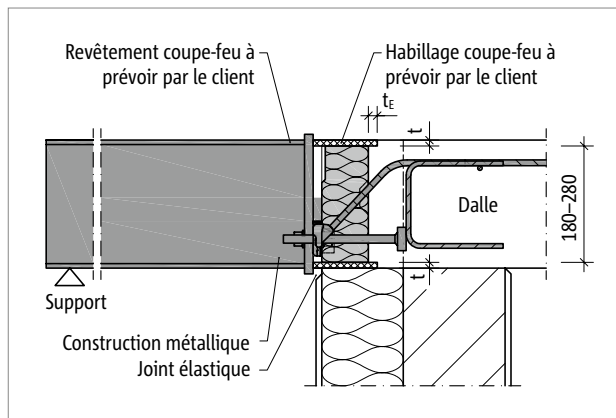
Schöck Isokorb® T type SQ : Bardage de protection incendie sur site - T type SQ, construction en acier avec revêtement de protection incendie ; coupe
